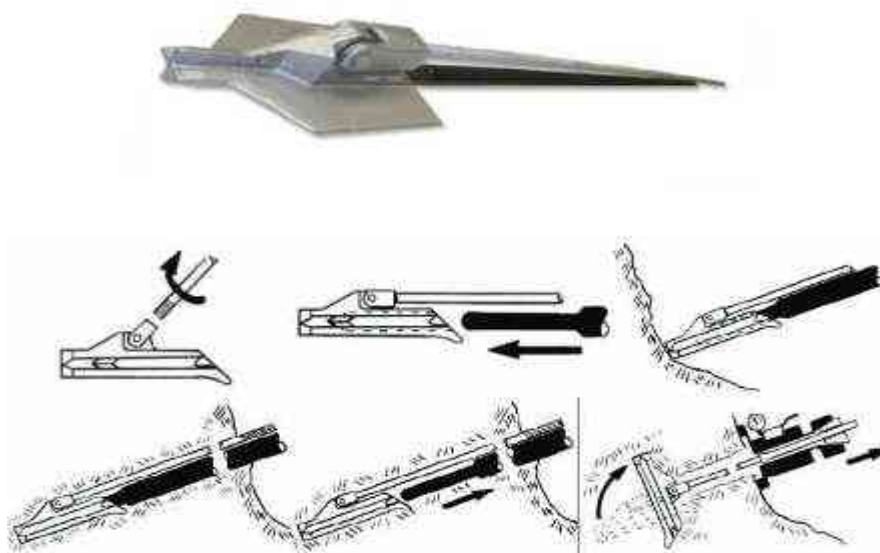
Anclaje Manta Ray e instalación del mismo.
